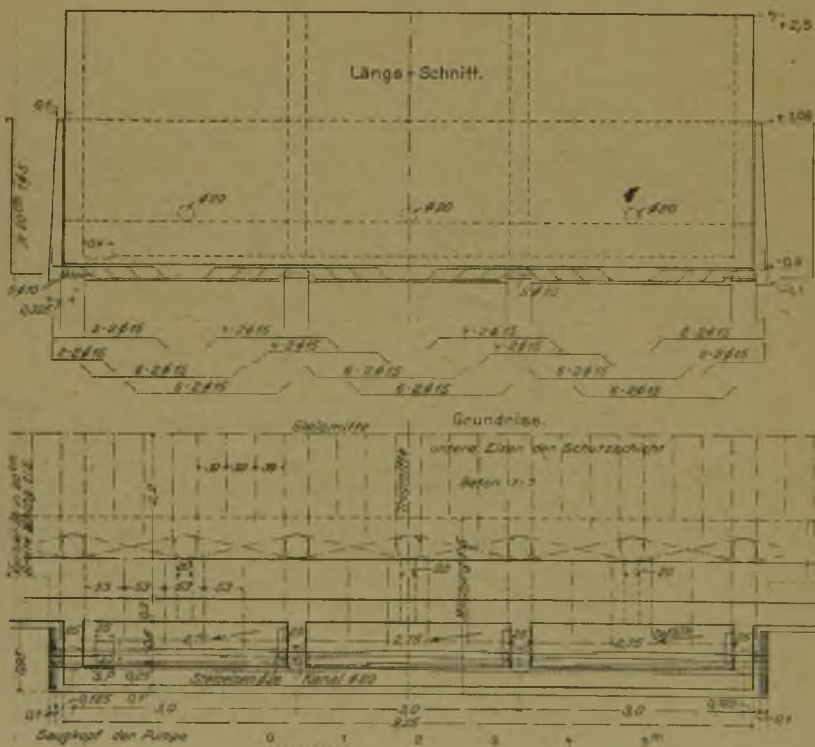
und b. Bewehrung des Eisenbetontrogges am Pumpensumpf.
